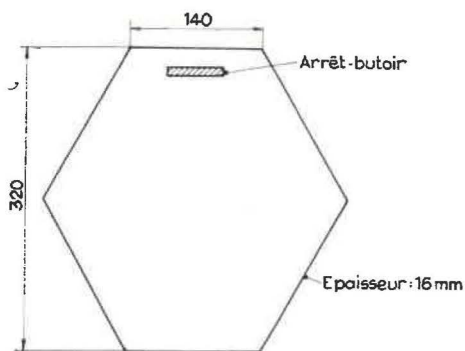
Semelle métallique placée sous le pied des caissons. La section de contact d'une semelle contre le mur est de 900 cm<sup>2</sup>.
